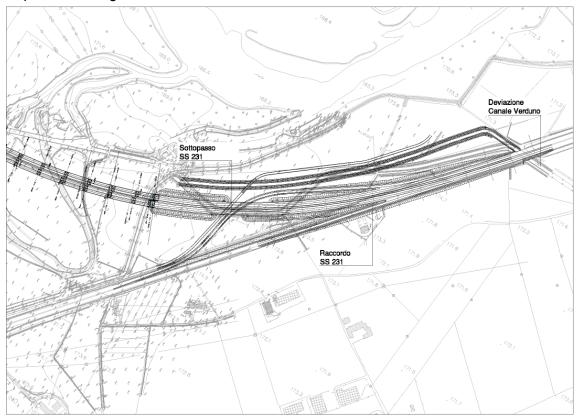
A Sviluppo planimetrico del tratto di adeguamento funzionale
